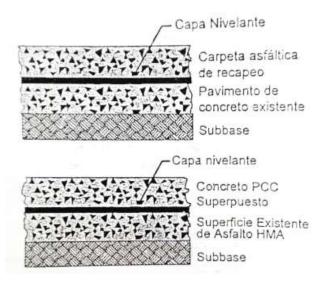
Pavimento Compuesto Fuente: Acurio, 2012
